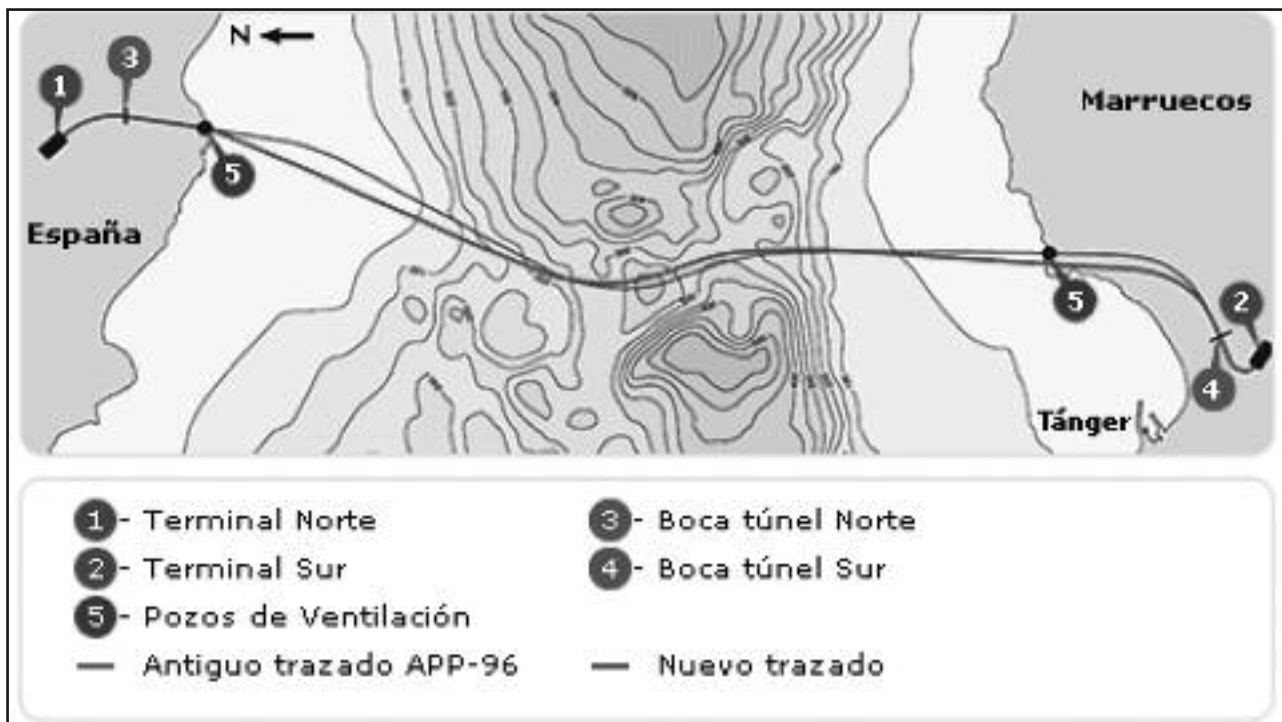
Planta esquemática mostrando dos trazados alternativos estudiados.
